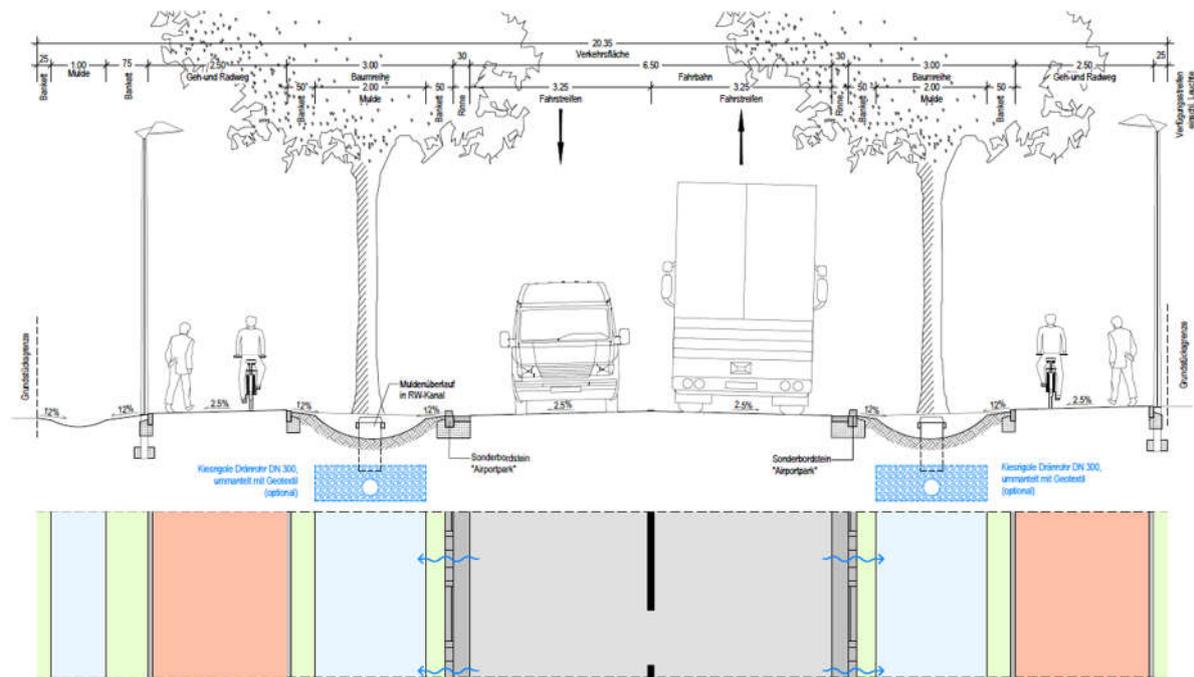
Regelquerschnitt Planstraße C; Planungsbüro Hahm Januar 2022
